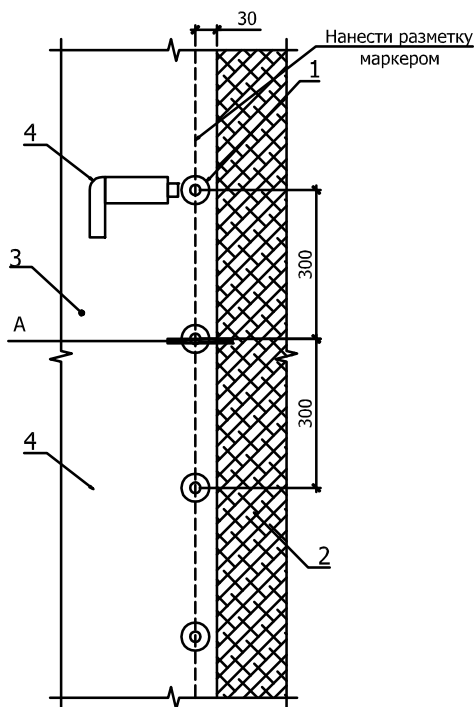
Технологическая схема производства работ по механическому закреплению полотнищ ПВХ-мембраны:
